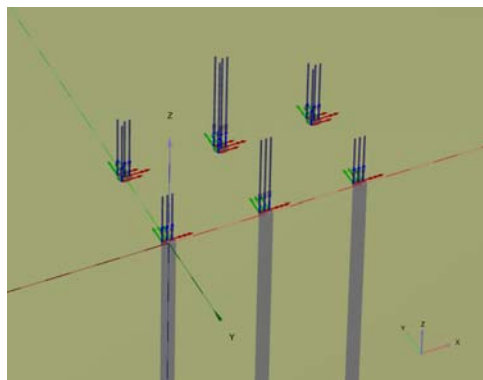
Surface load* bei vernachlässigter Oberbaustruktur
